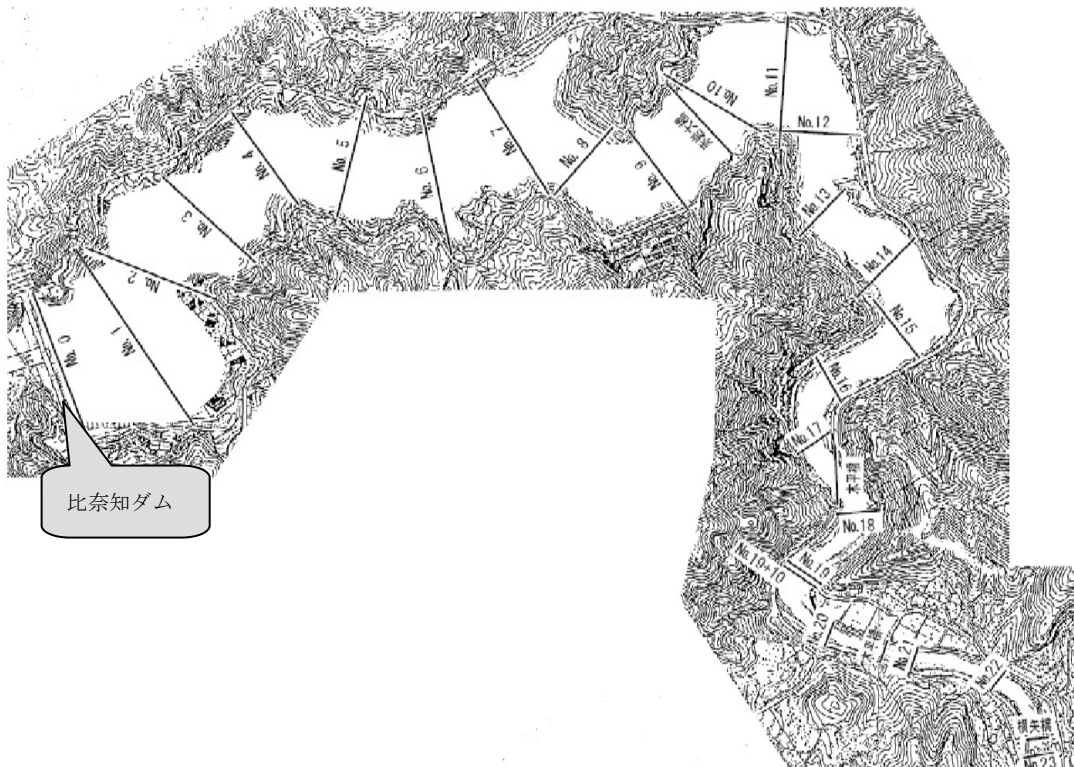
比奈知ダム堆砂測量平面図(測線図)
